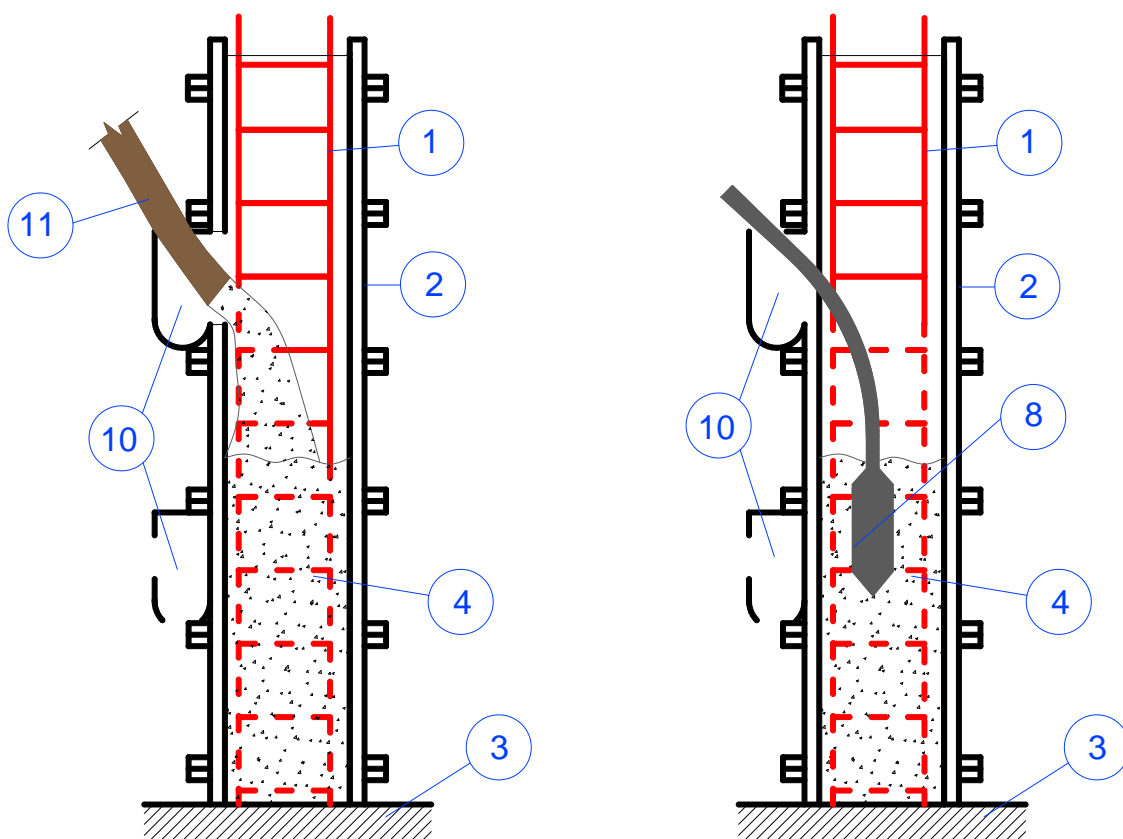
Схема укладки и уплотнения бетонной смеси при бетонировании конструкций стен
